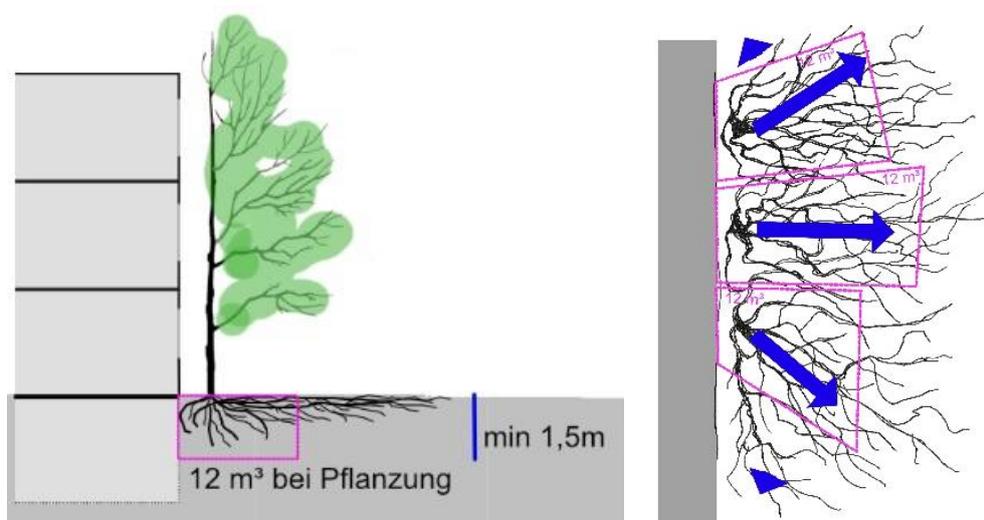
Schnitt - Wurzelentwicklung weg vom Gebäude (links); Aufsicht - Wurzelraumdimensionierung und -ausbreitung, unterirdisch, schematisch an einer Baumfassade mit 3 Bäumen (rechts) (Lisa Höpfl)
